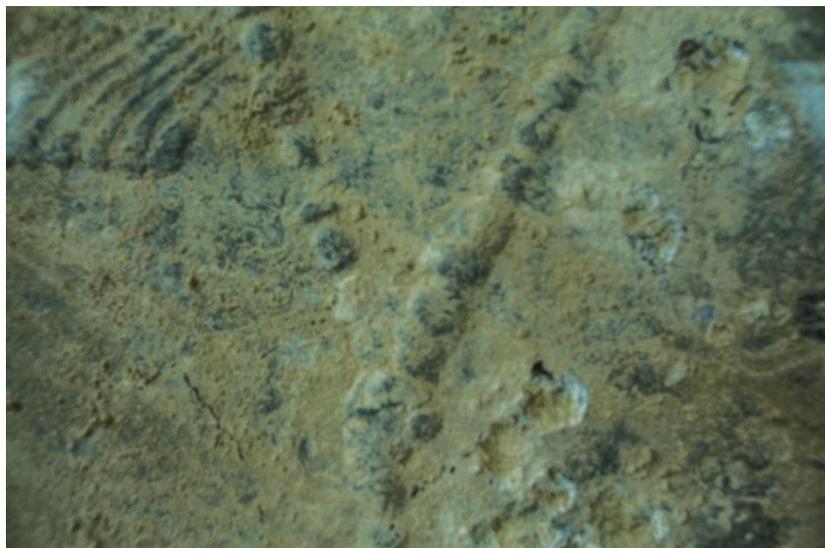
Detalle de la junta con la ausencia de máscara. Imagen: elaboración propia.
